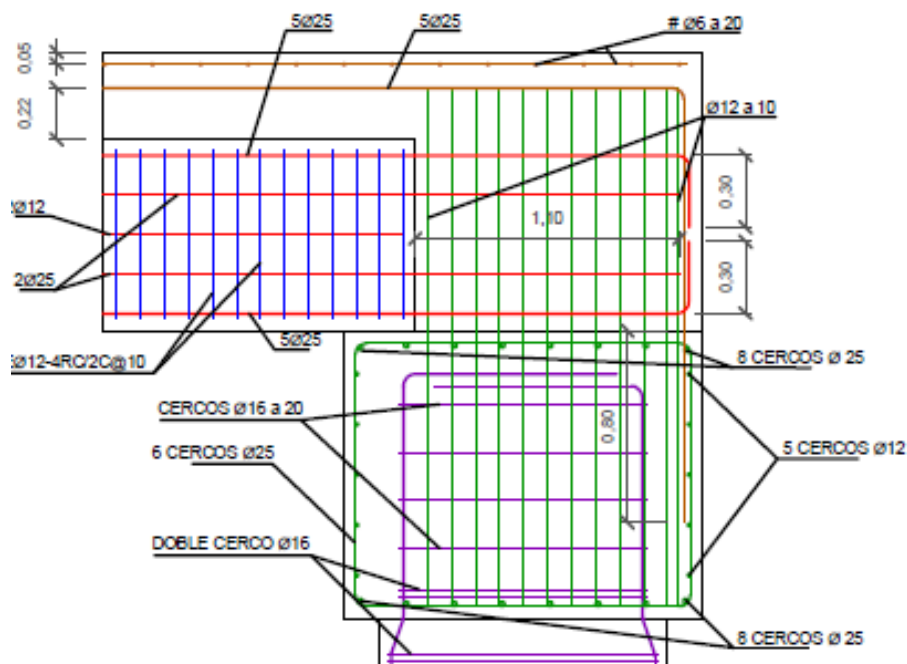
Armadura de junta plataforma, apoyo pasarela.
